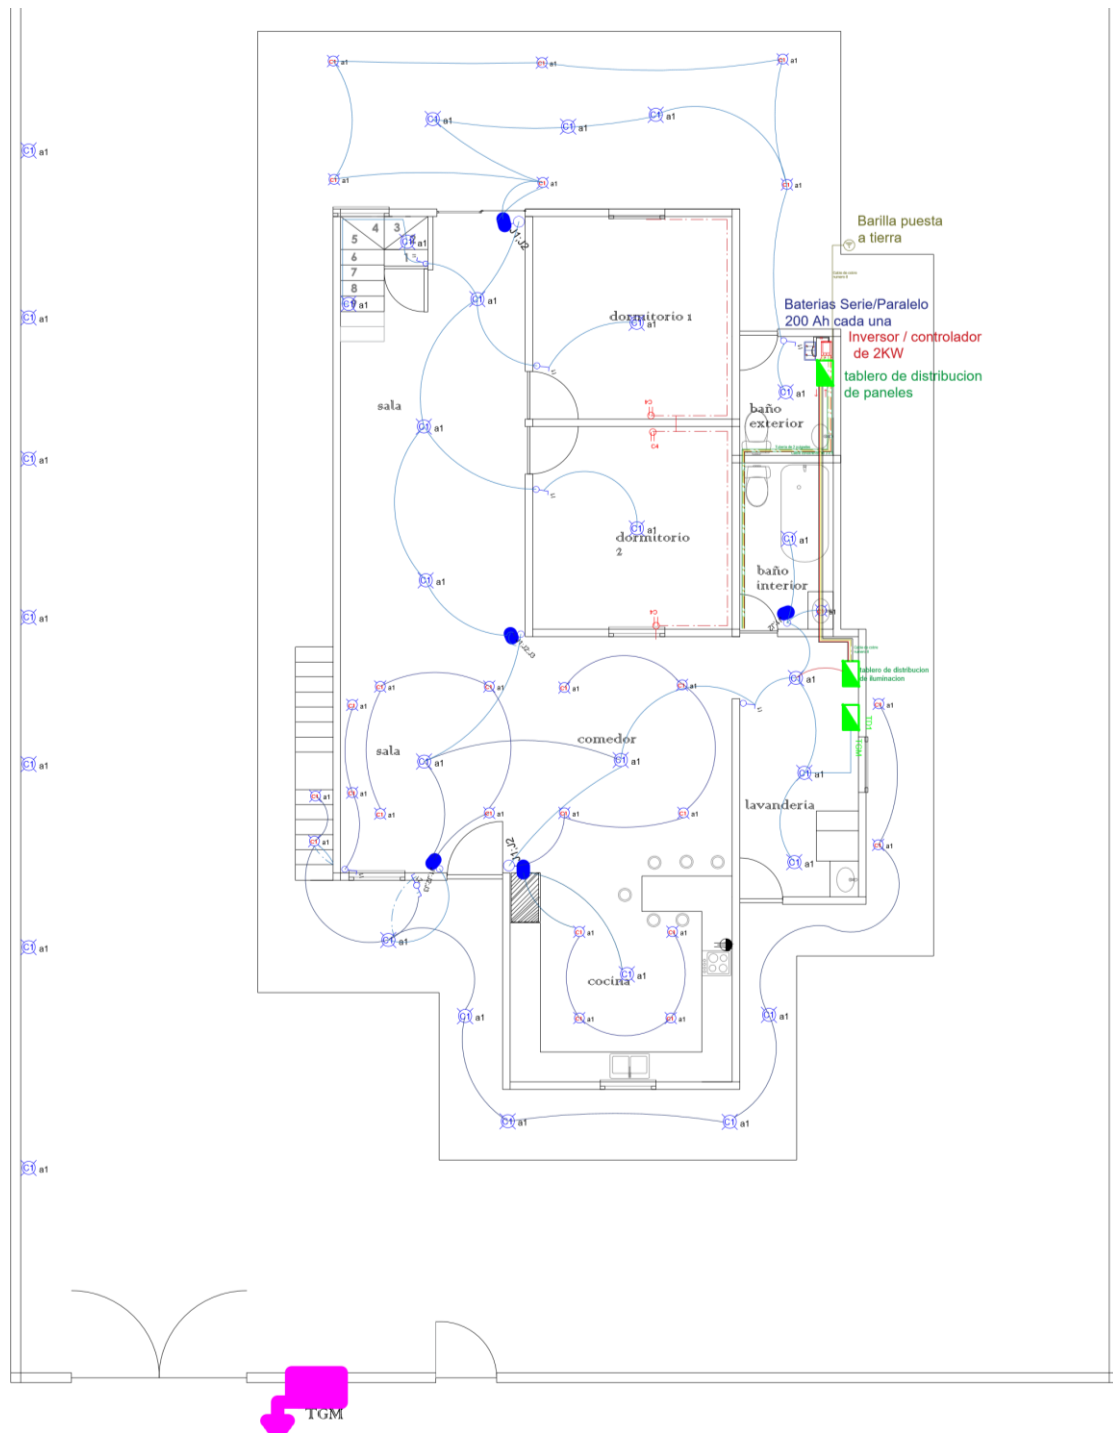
Plano de la vivienda en la parte de abajo la cual se encuentran los equipos a instalar (CAD).
